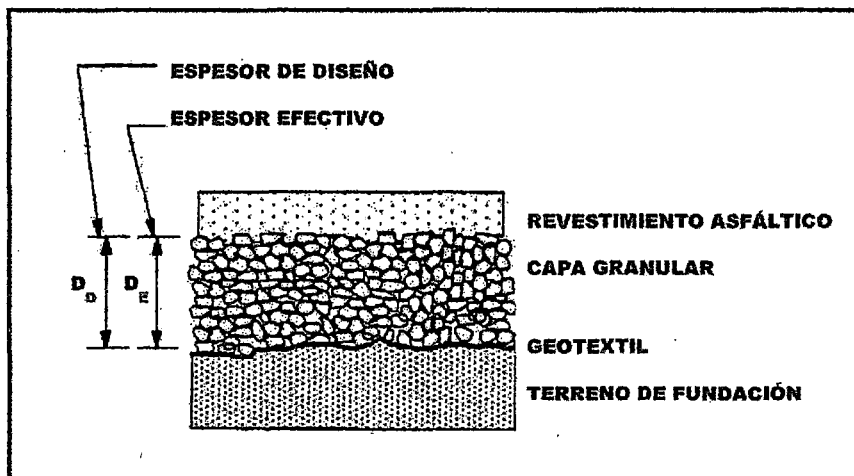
SECCIÓN DE PAVIMENTO CON GEOTEXTIL DE SEPARACIÓN
